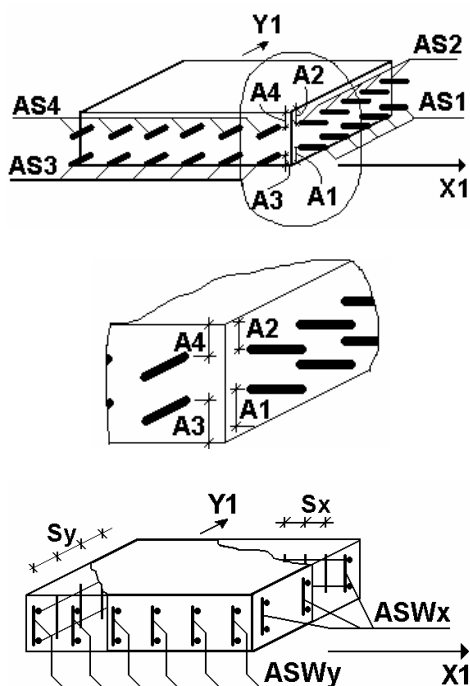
Армирование элементов железобетонной оболочки
